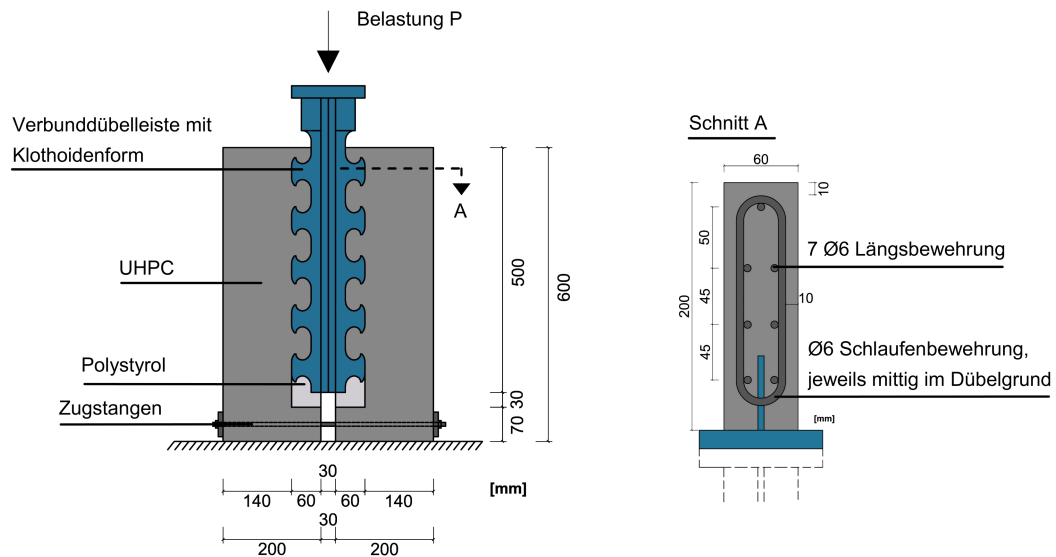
Push-Out Versuchskörper mit Bewehrung
